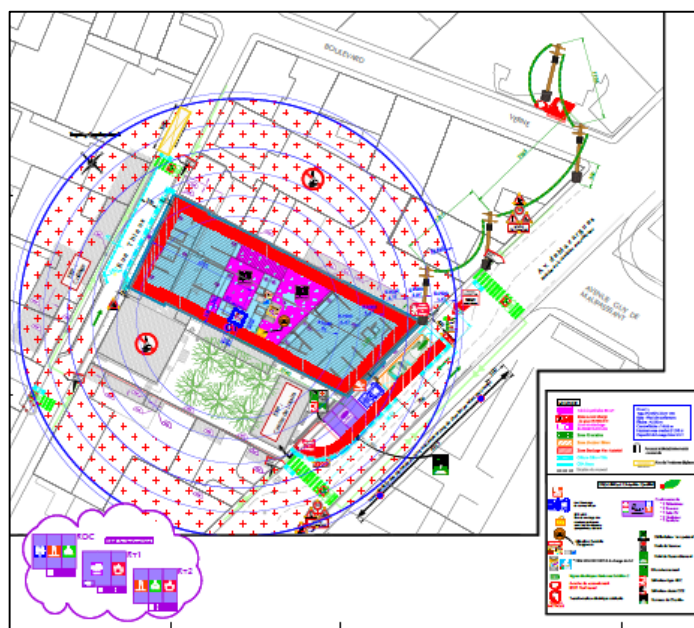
Plano de implantação do estaleiro da obra [138]
